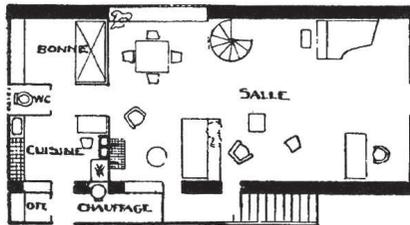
Erdgeschoß Typenhaus Citrohan
